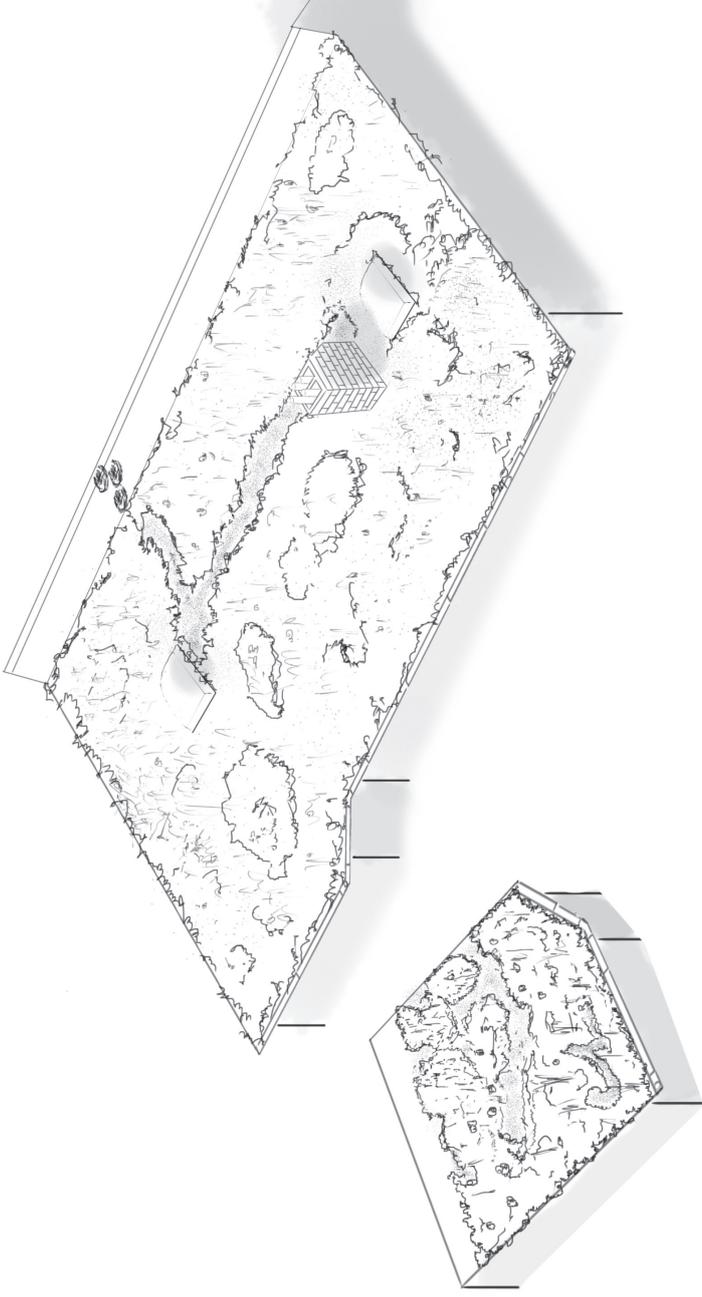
Extensive Dachbegrünung auf dem Hausdach und dem Dach vom Anbau.
